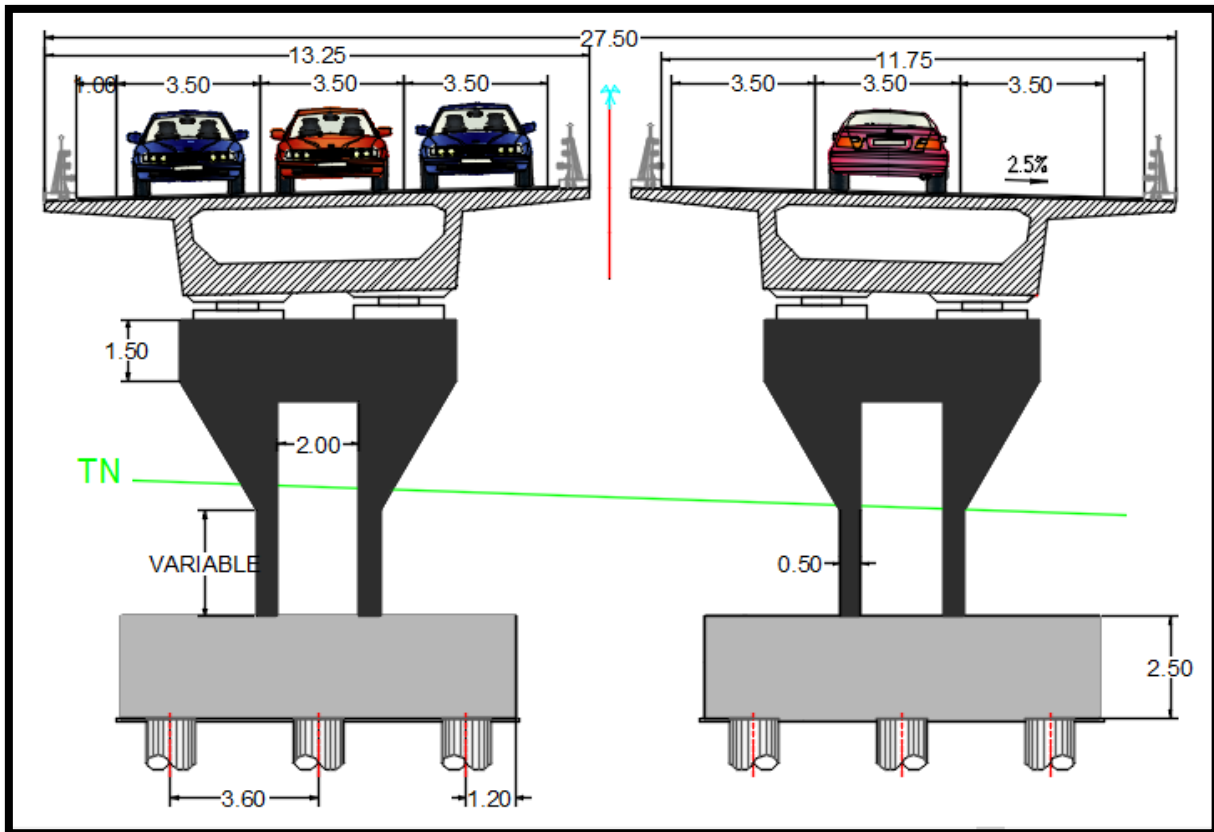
Coupe transversale sur pile VARIANTE 02
